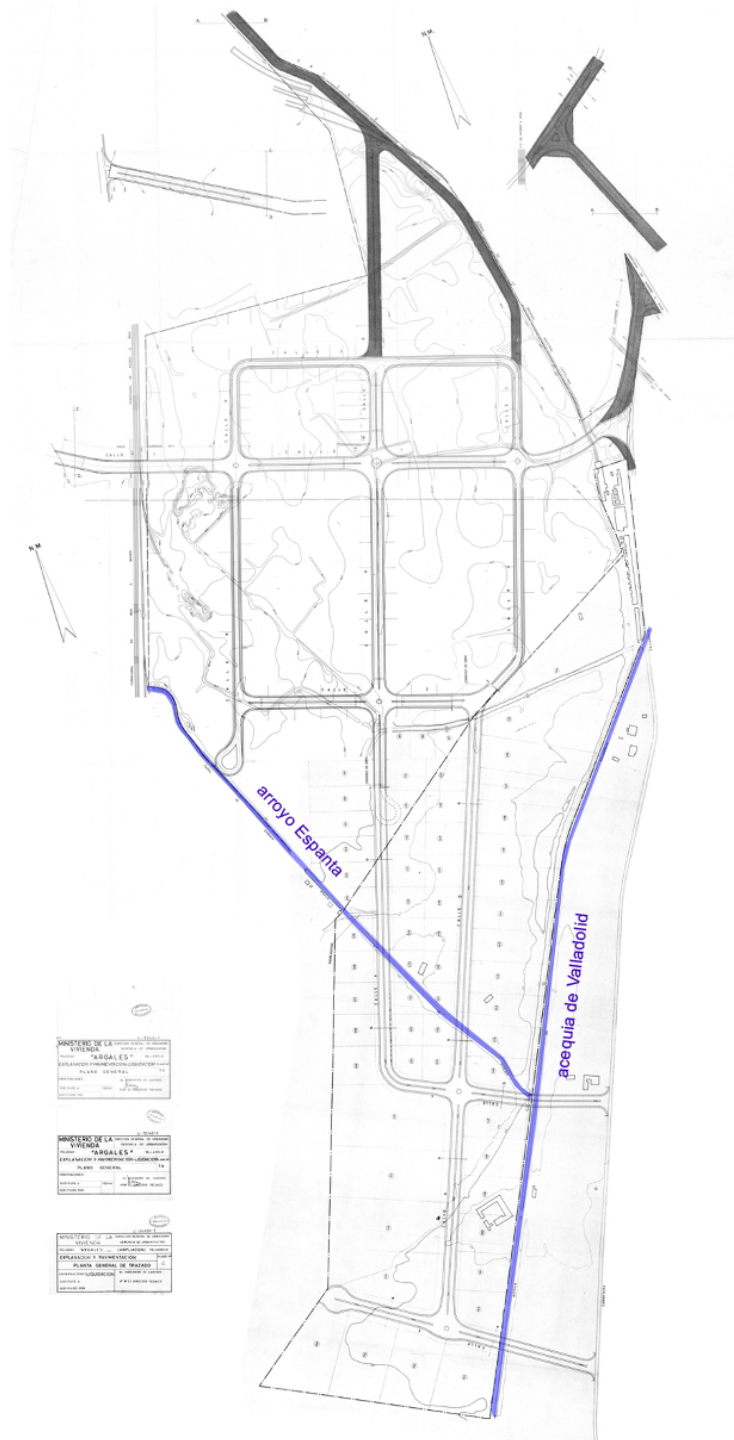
Montagem dos planos originais da zona de Argales. Fonte: Archivo Municipal de Valladolid: Caja 9141, planos 1 e 2. Liquidação das obras de urbanização (nivelamento, pavimentação, rede de saneamento e abastecimento de água da zona de Argales). 1968; e C 31838-1. Ministério da Habitação. Liquidação das obras de urbanização (nivelamento e pavimentação) da zona industrial de Argales (ampliação). 1972. No meio do gráfico, pode-se ver a linha que divide as duas fases da área.
